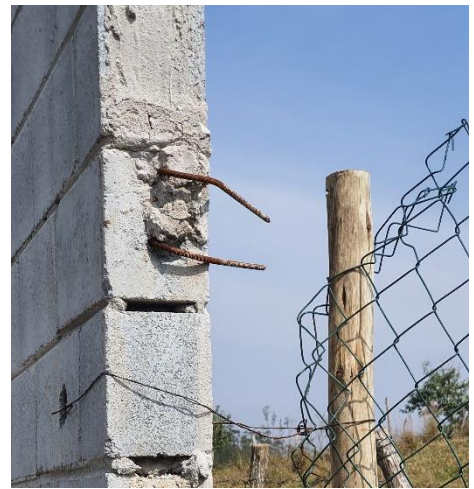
e 04 – Cintas de amarração do muro.
